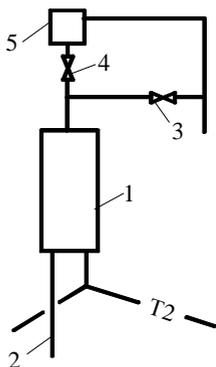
Схема установки воздухоборника для централизованного удаления газов: 1-воздухоборник; 2-главный обратный стояк; 3,4 –вентили; 5-автоматический воздухоотводчик
